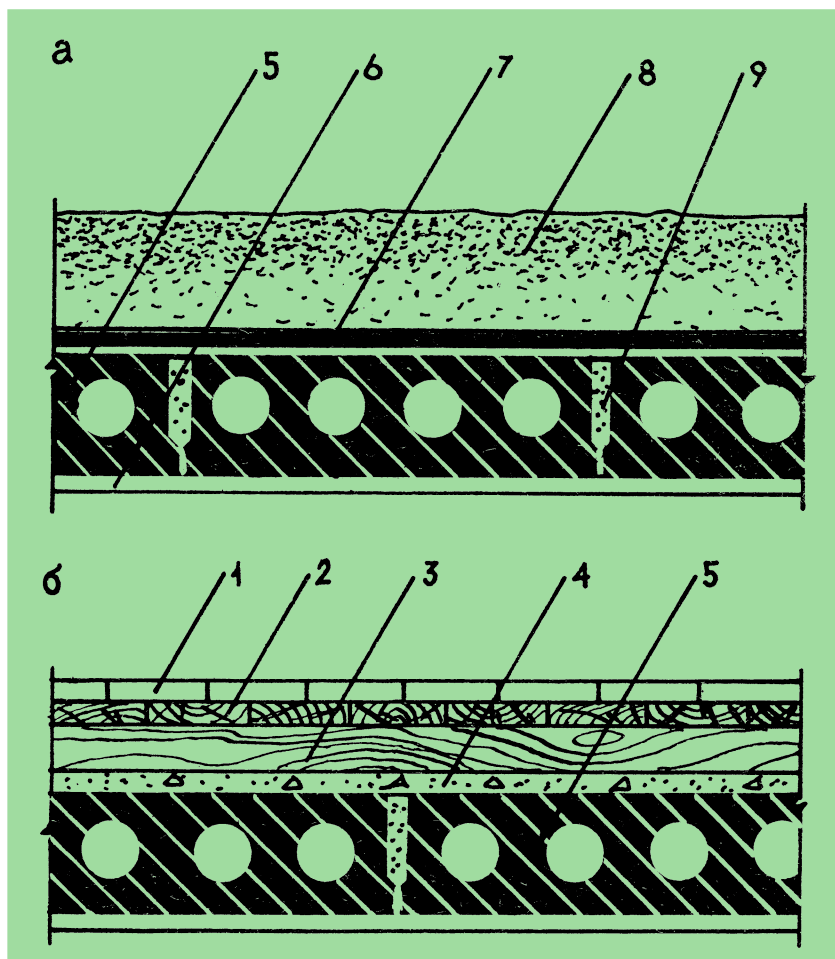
Перекрытие из сборных железобетонных плит с круглыми пустотами:
